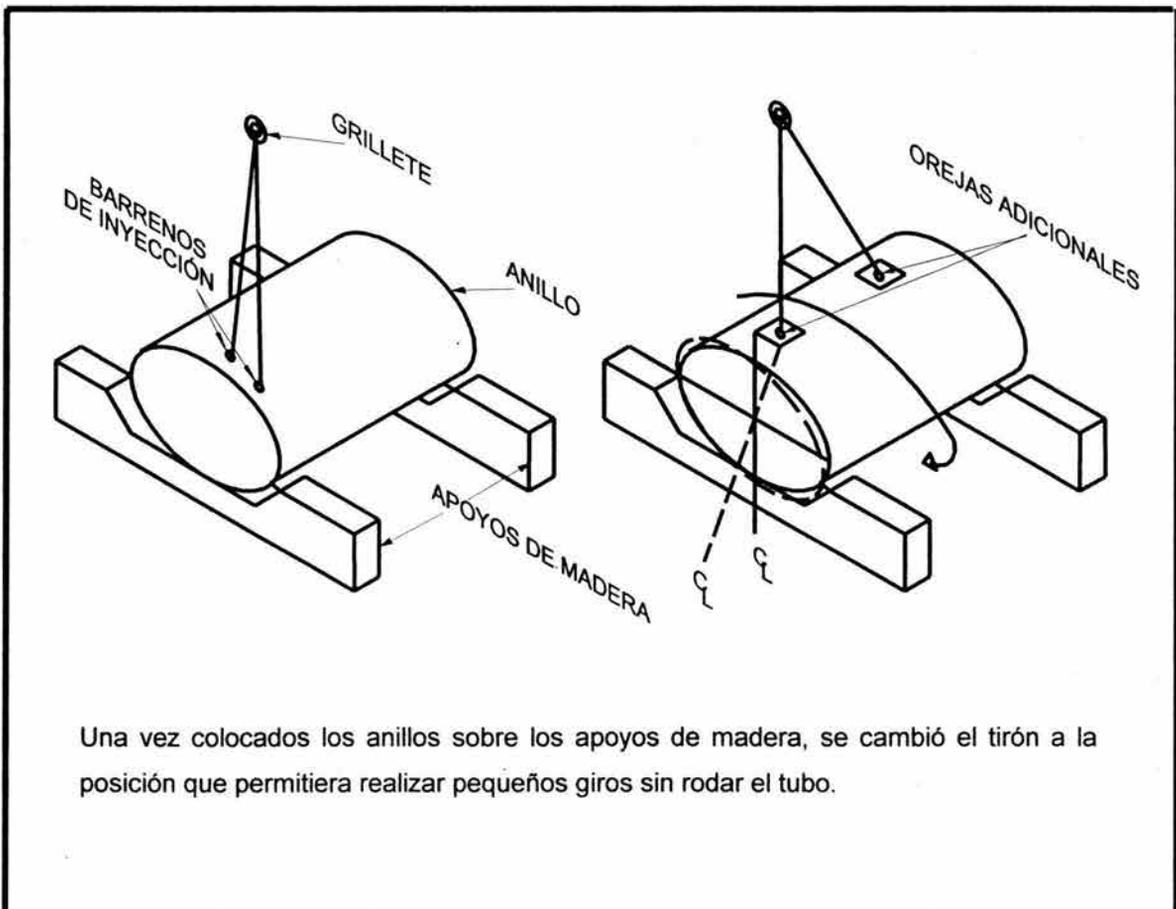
GIRO DE LOS ANILLOS METÁLICOS
